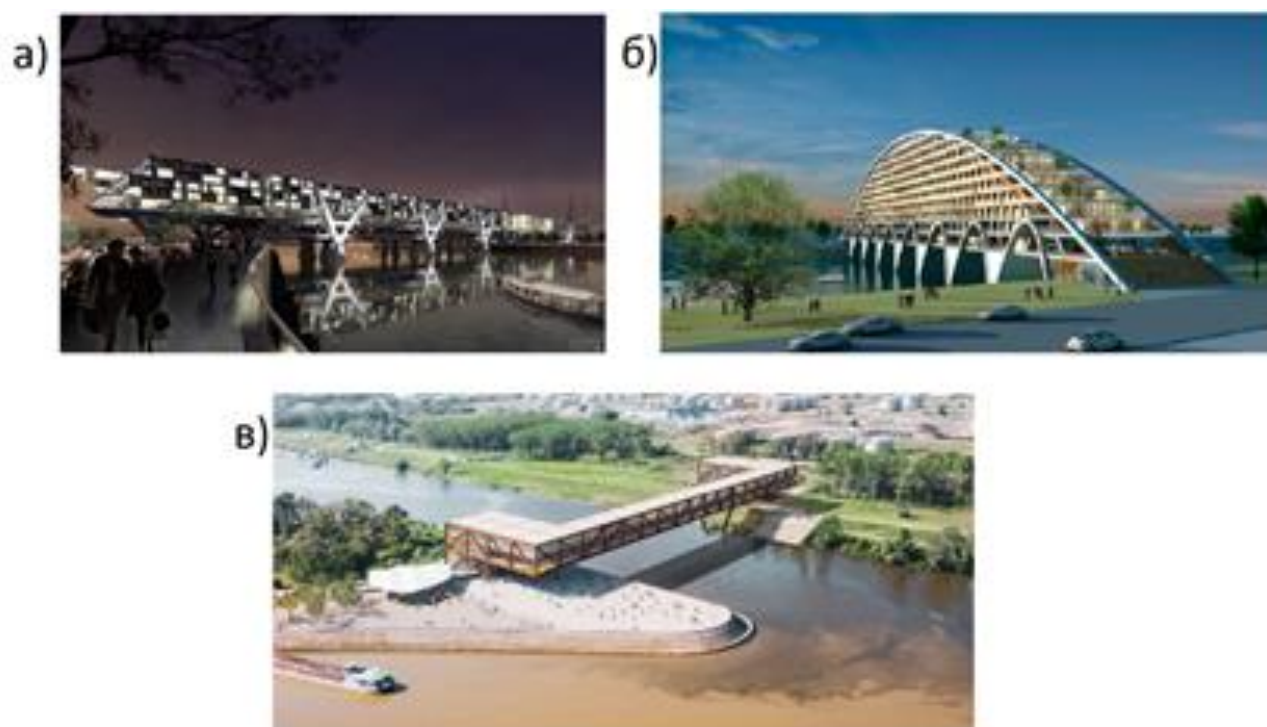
Примеры современных проектов мостов со зданиями: а – Living Bridge в Гамбурге; б – Living Bridge в Дуйсбурге; в – Elbow Shadow Bridge
